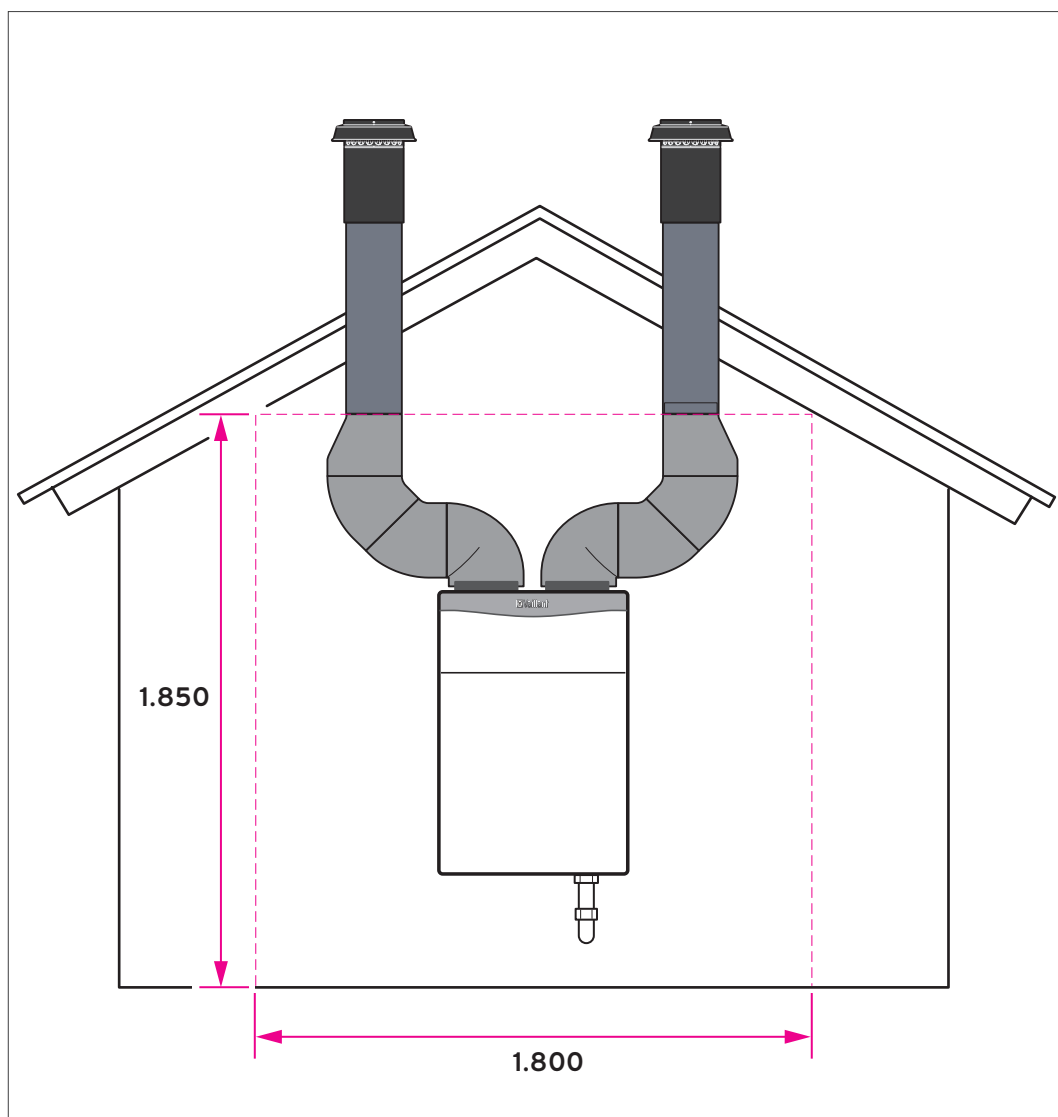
recoVAIR VAR 260/4 – Montage im Dachgeschoss
